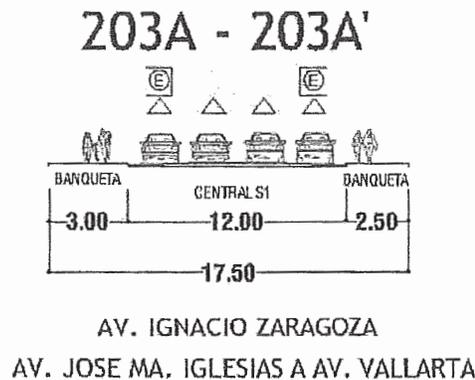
Sección de la Av. Zaragoza, de acceso al predio.
